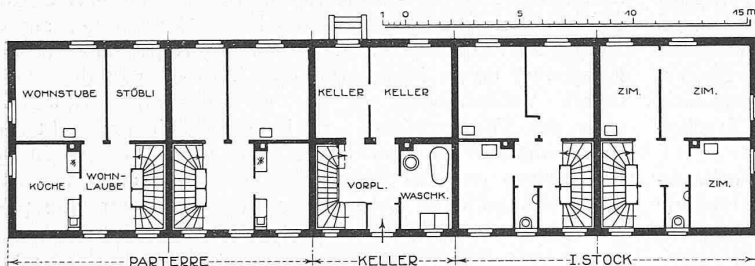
und 3. Grundrisse 1 : 500 und Nordwestansicht der Wohnkolonie Friedberg, Luzern.
